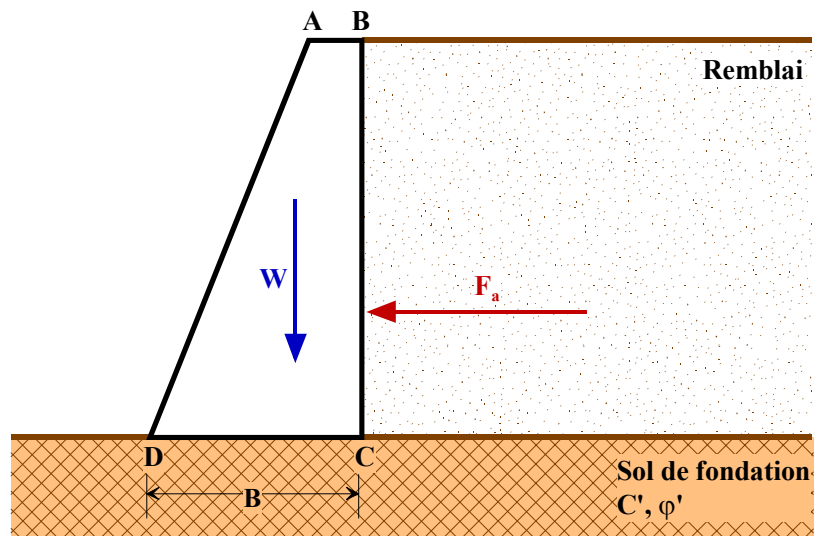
Application des forces horizontale et verticale sur la base du mur
